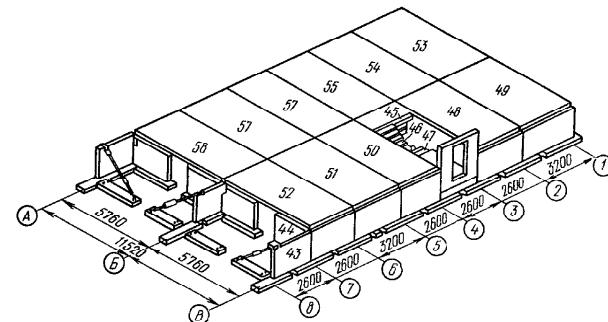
Последовательность монтажа плит перекрытия над подземной частью здания (показана цифрами)
